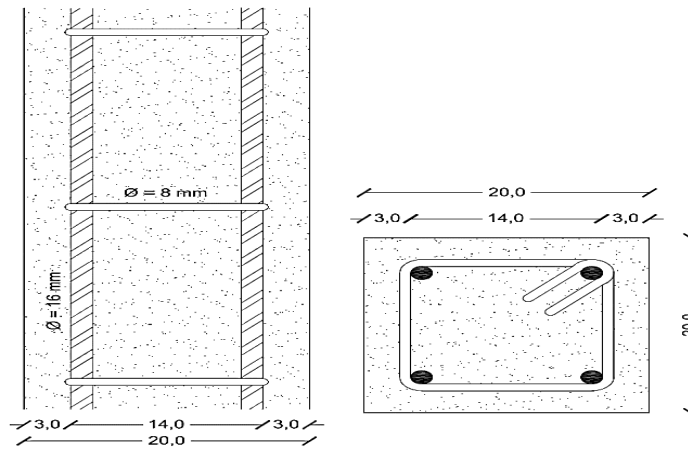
Representação esquemática das seções transversal e longitudinal dos pilares P1 e P2 (medindo 20x20 cm de seção transversal), cobrimento de 3,0 cm e as armaduras principais com bitola de 16 mm e estribos com bitola de 8 mm.
